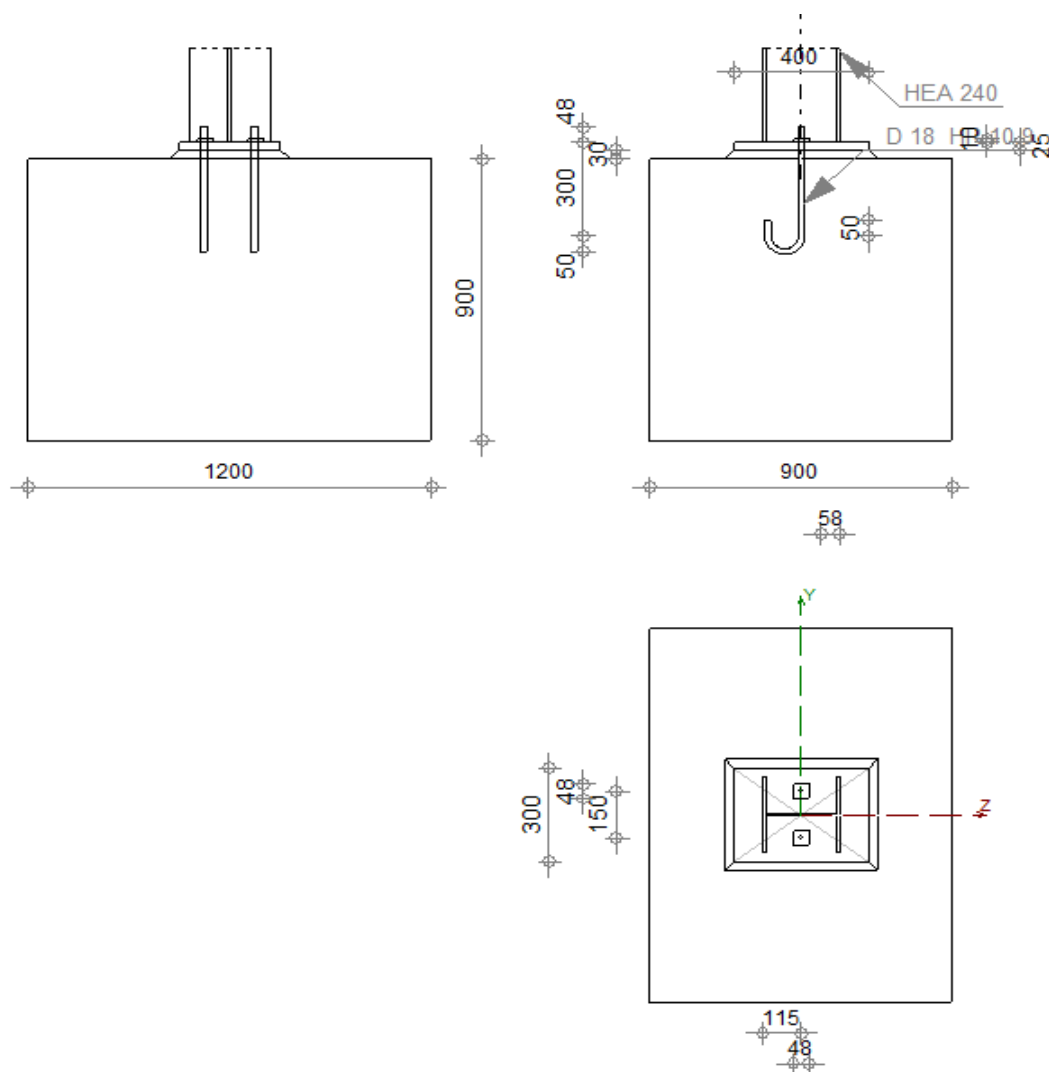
vue en plan de l'assemblage pied de potelet.
